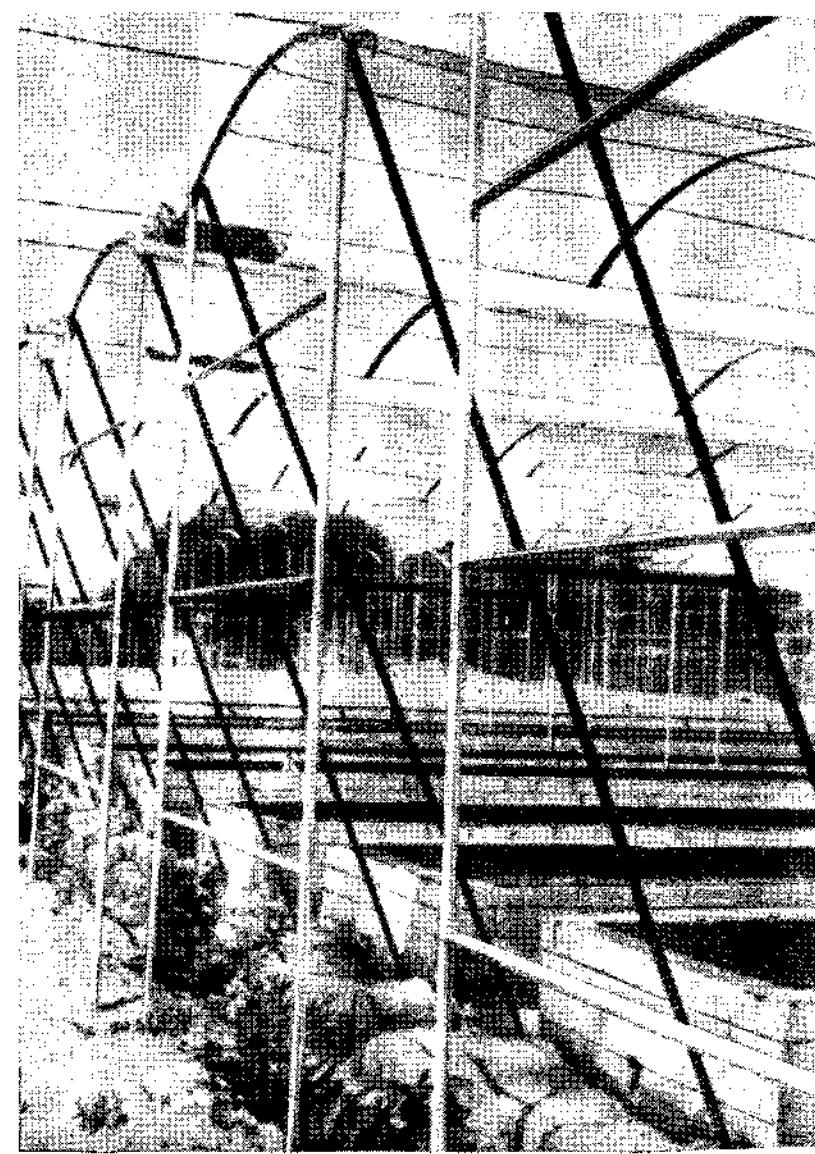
Опоры из труб для укрытия поддонов пленкой.
